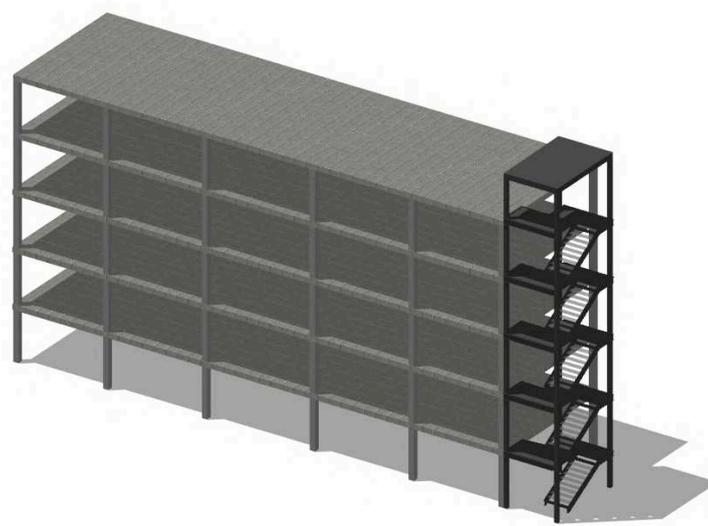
Modelo estrutural, pilares de concreto e laje nervurada. Fonte: Autoria própria
